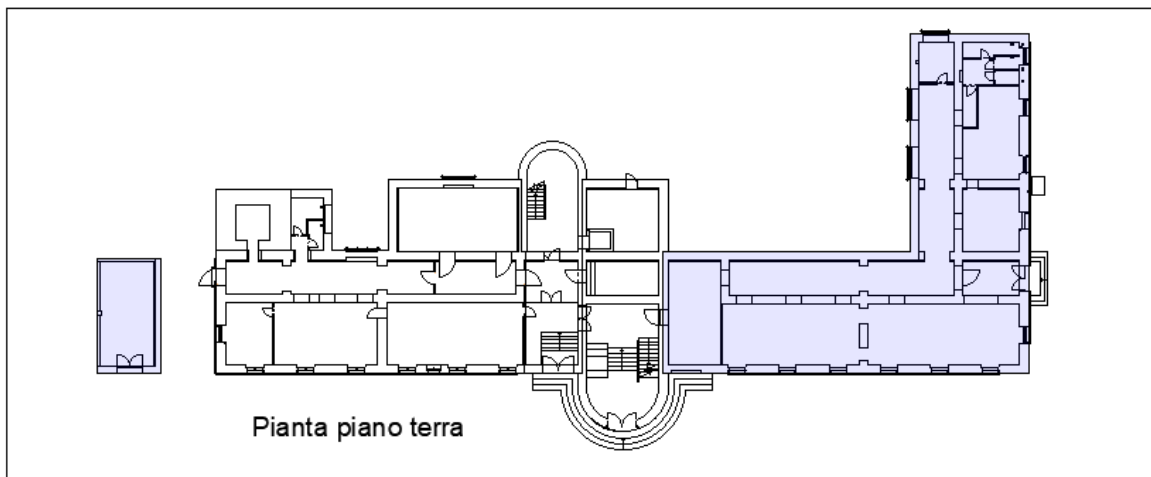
Spazi da assegnare al Comando provinciale della Guardia di Finanza - piano terra
